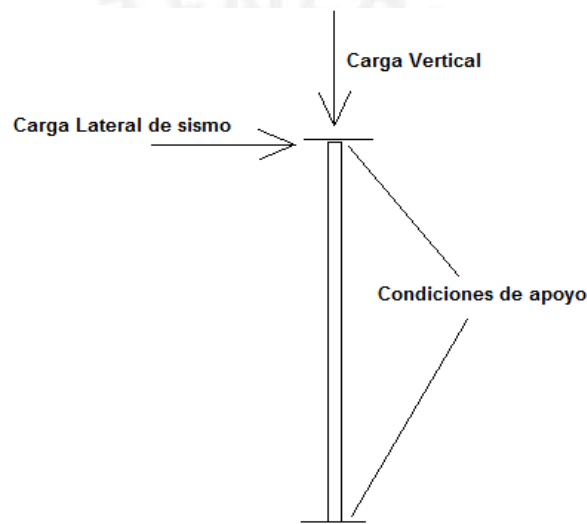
Elemento vertical sometido a cargas verticales y laterales.
